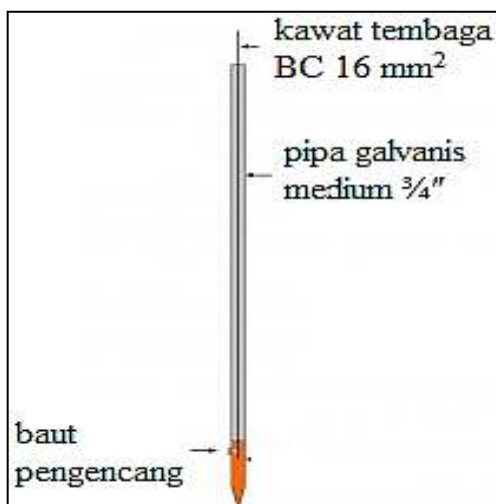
Contoh Pemasangan Instalasi Grounding Rumah
